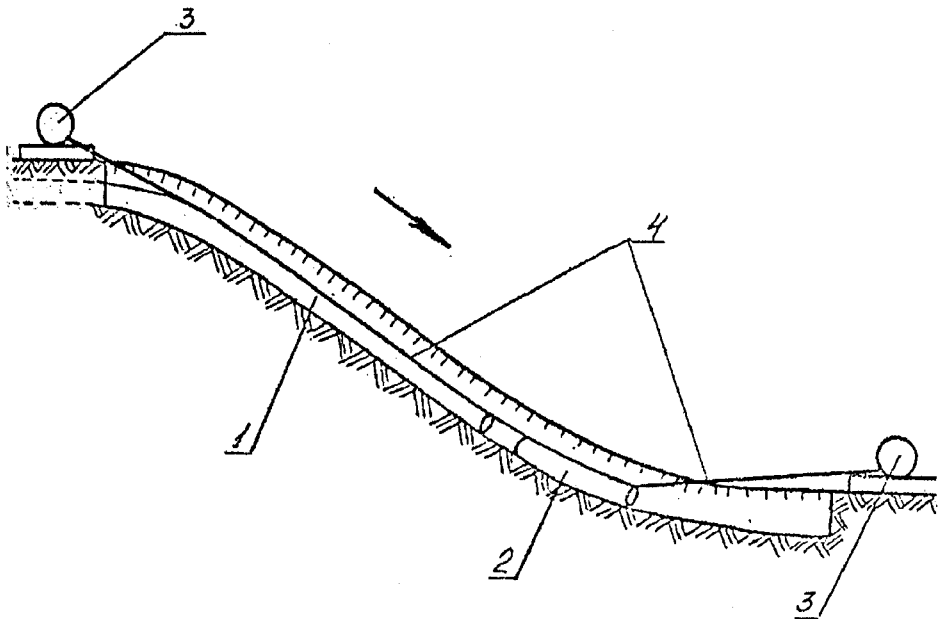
Технологічна схема демонтажу газопроводу при поздовжньому схилі понад 30° :
